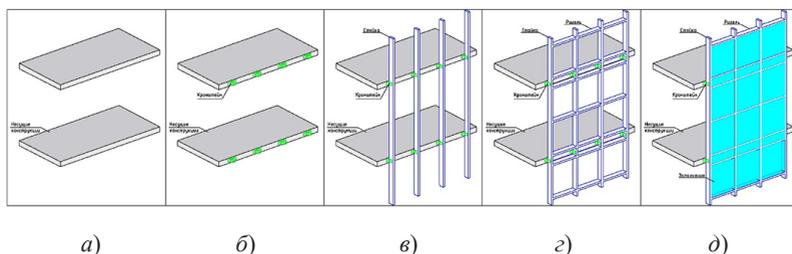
Последовательность выполнения работ при монтаже стоечно-ригельной системы: а – на несущий каркас; б – установка кронштейнов; в – монтаж стоек, каркаса; г – монтаж ригелей каркаса; д – монтаж заполнения
